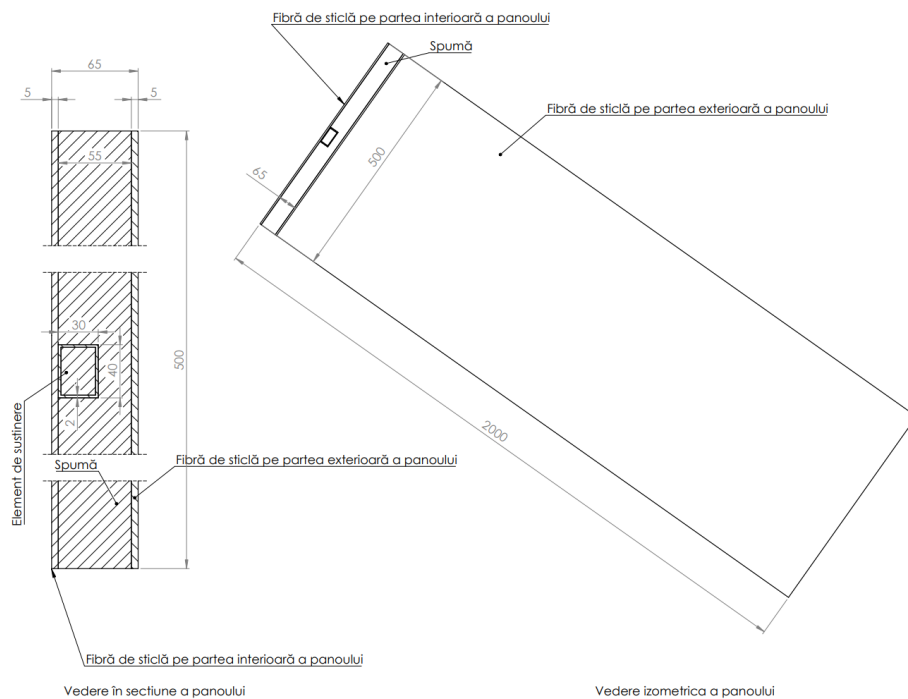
Structura panoului izoterm, cu element de susținere din țevă rectangulară.
